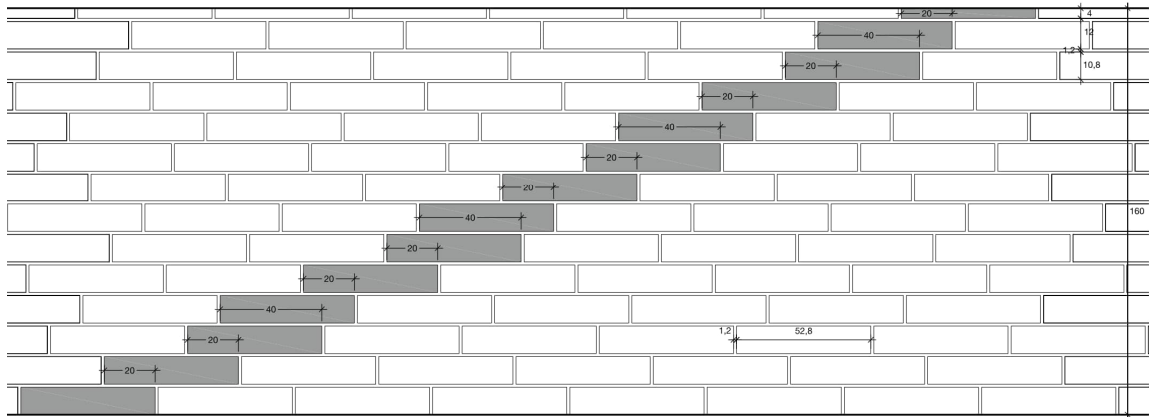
Auszug aus Ausführungsplan – Verlegeplan
